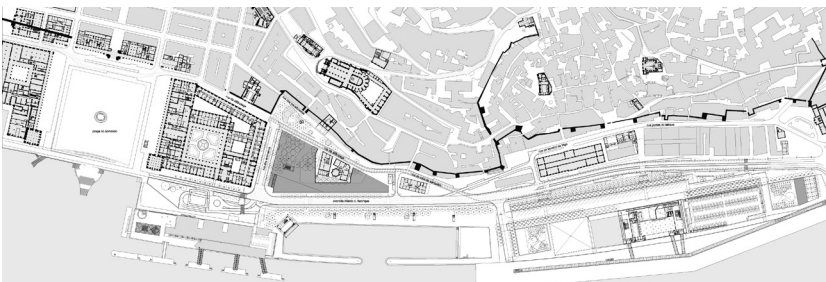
Planimetria del lungofiume dalla Praça do Comercio ai Jardim do Tabaco, Terreiro do Trigo e Terminal Crociere. gentile concessione di @Global Arquitectura Paisagista.
